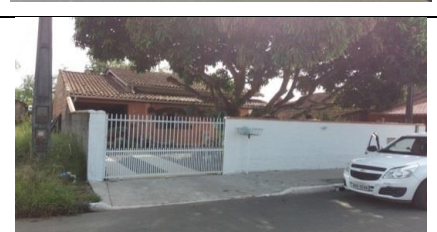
FOTOS DOS IMÓVEIS A DEMOLIR E CONSTRUIR
